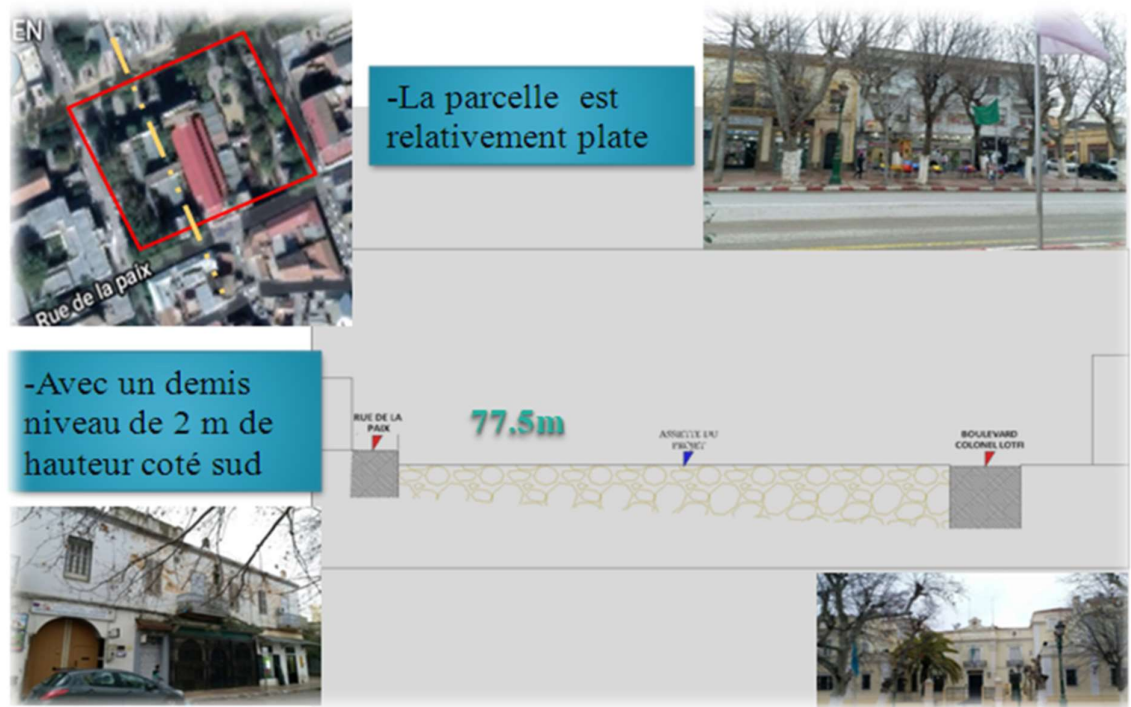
coupe transversale sur l'assiette d'intervention (Source auteur)
